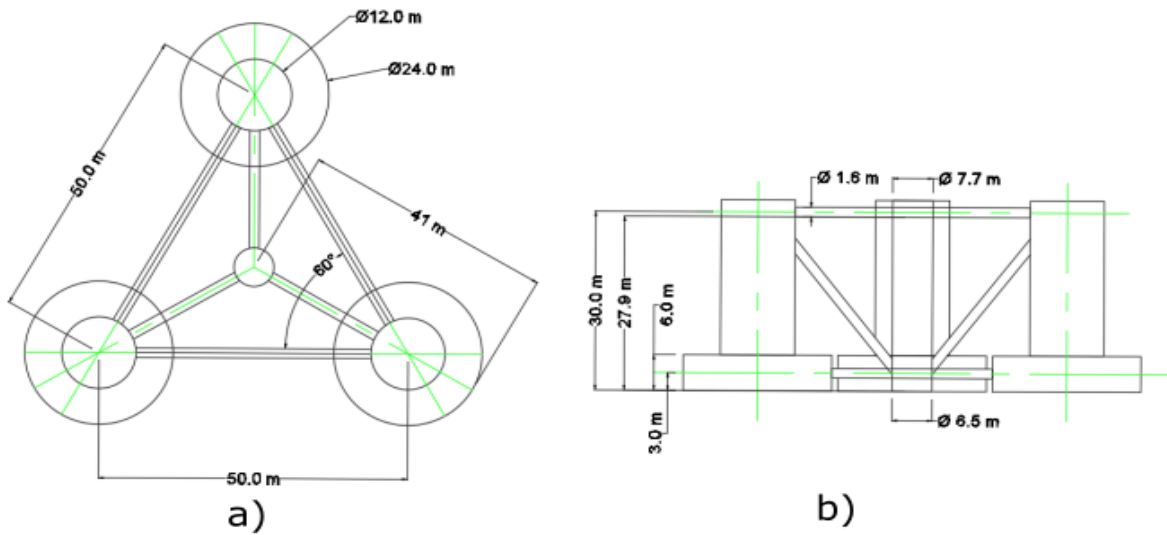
Vista en planta a) y vista en alzado b) de plataforma semisumergible (Robertson, Jonkman, Masciola, et al., 2014).
